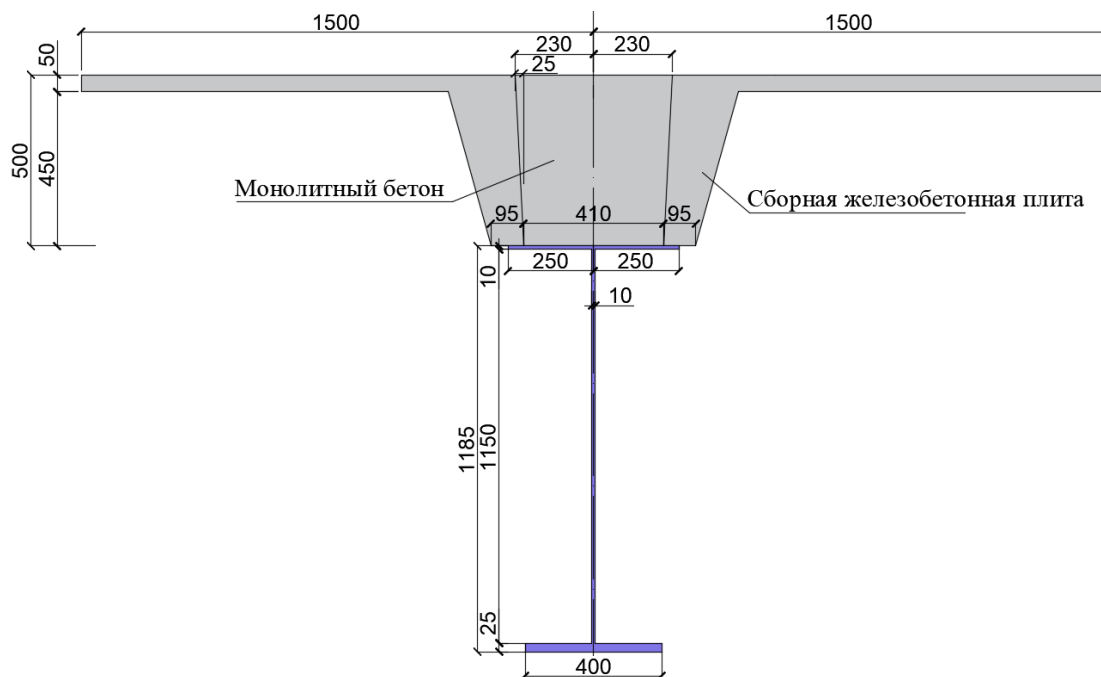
Поперечное сечение сталежелезобетонной балки № 1
